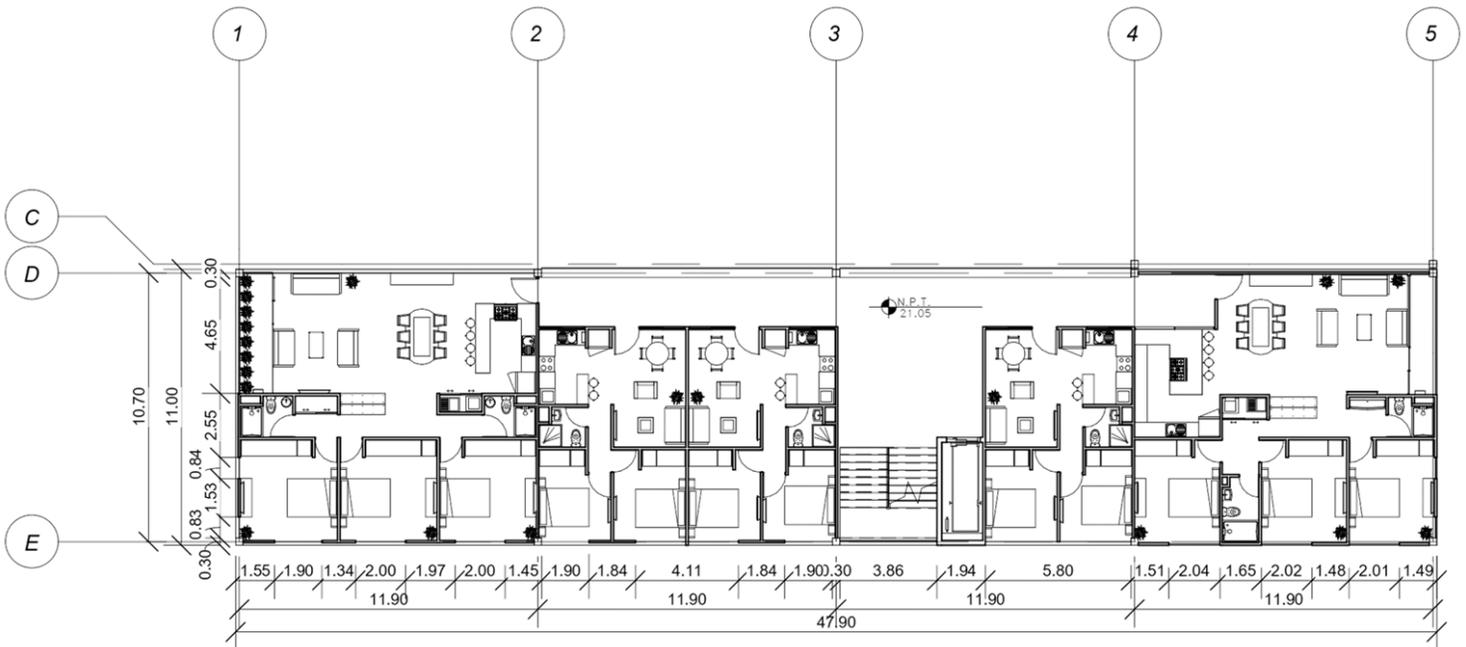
Propuesta final. Planta nivel siete. Elaboración propia. 2022
